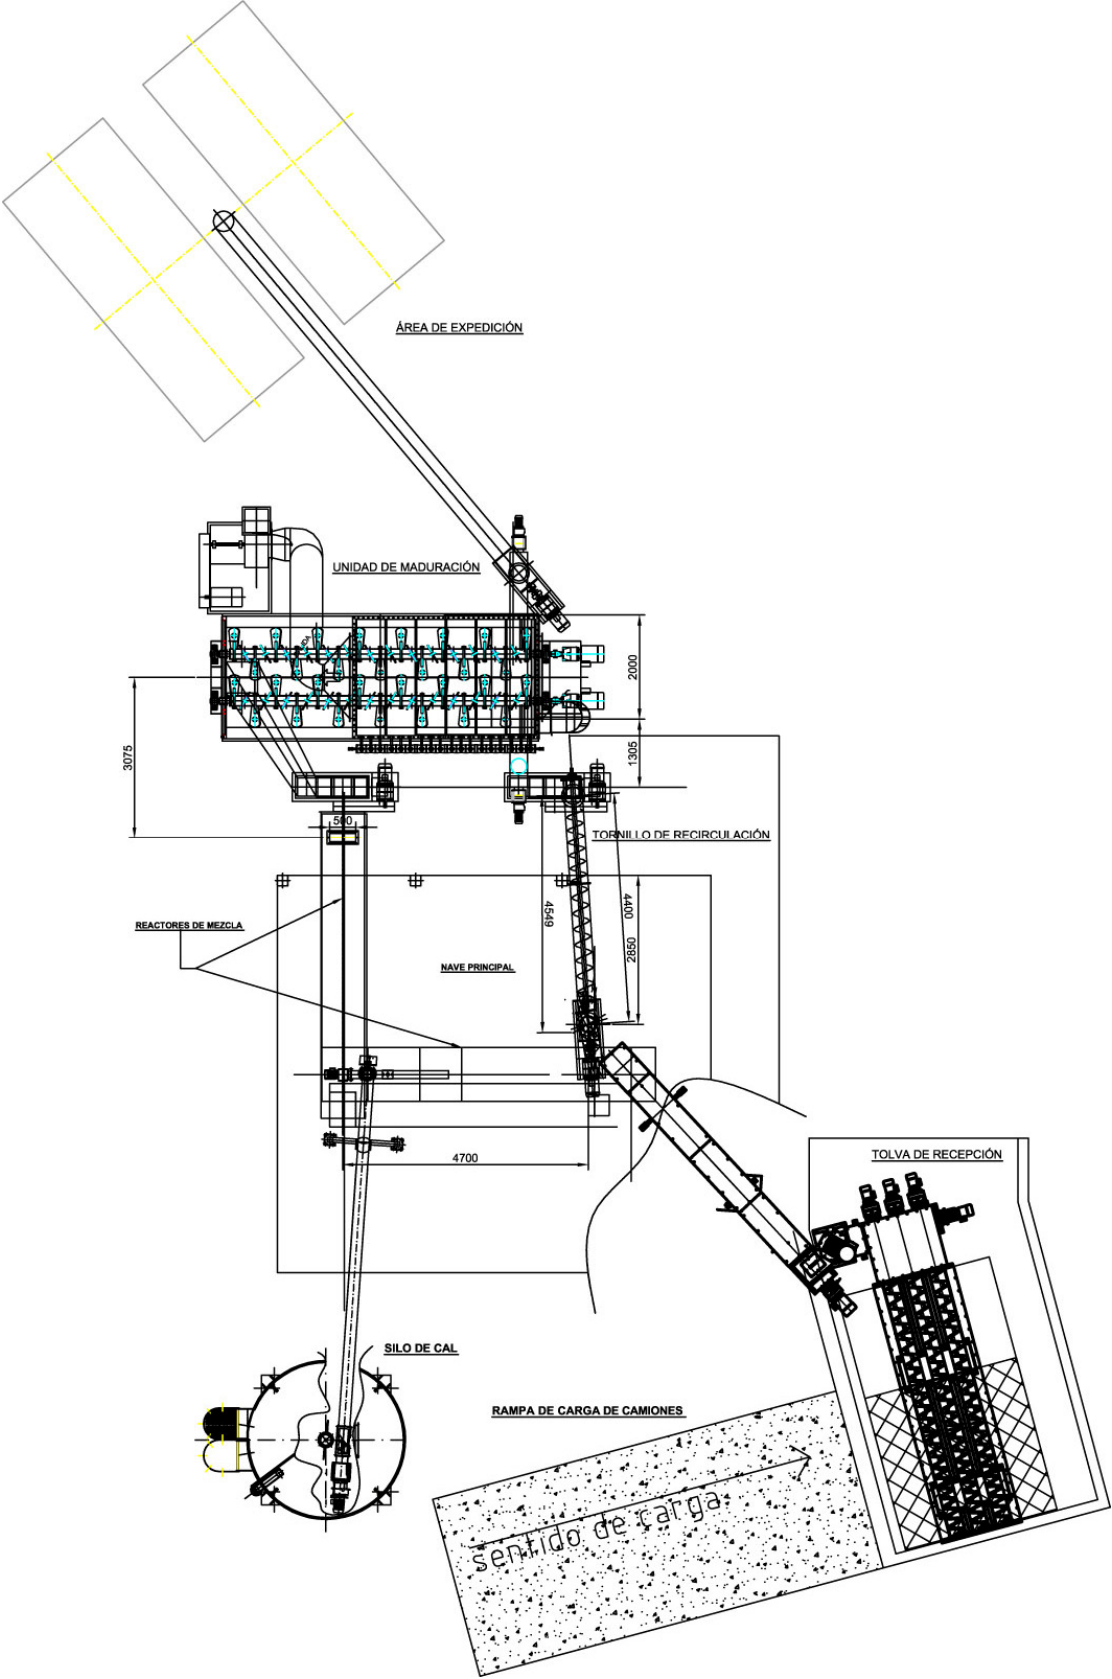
Detalles constructivos de los reactores de mezcla Alchimix.
